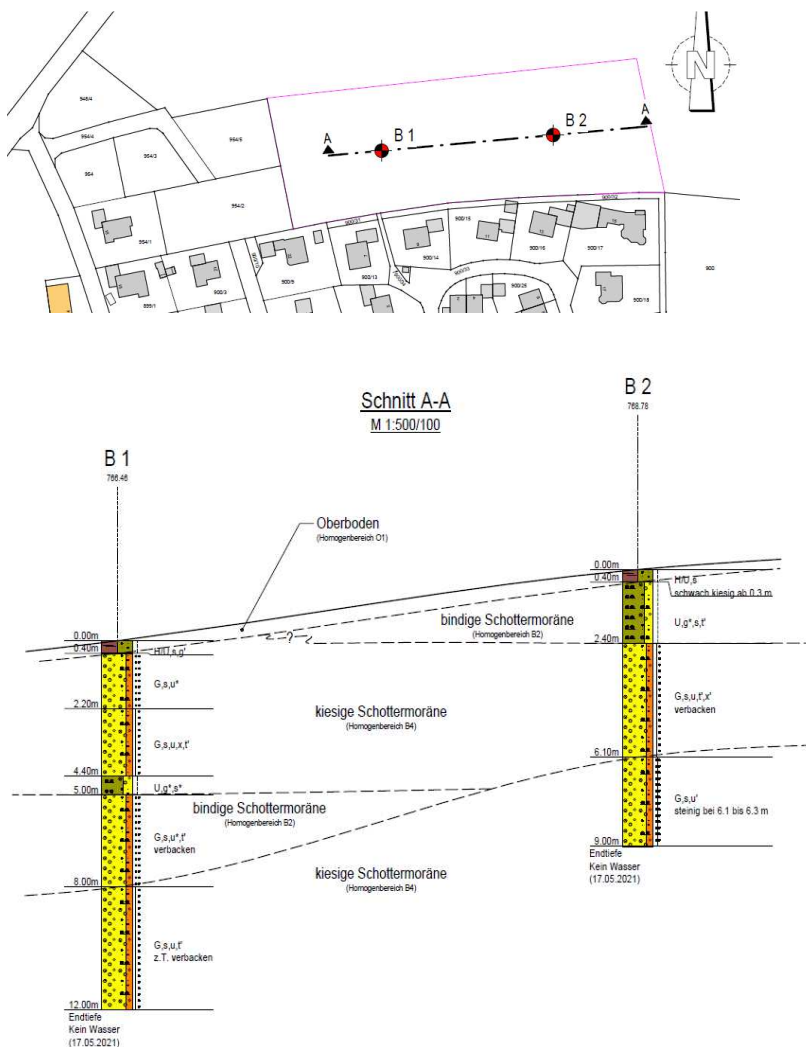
Lageplan mit Aufschlusspunkten und Schnitt mit Bohrprofilen ( Crystal Geotechnik, Juli 2021)
